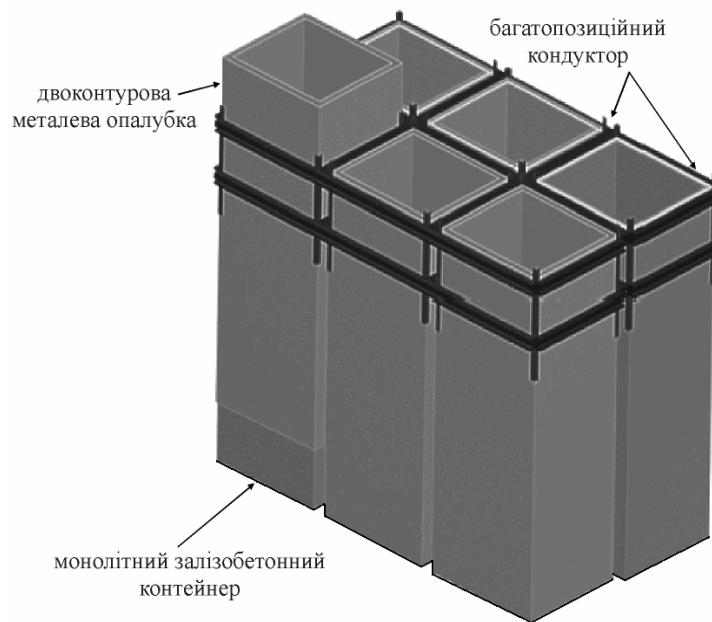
Зовнішній вигляд багатопозиційного кондуктора чарункового типу
